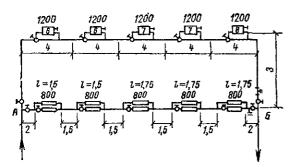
28 Горизонтальные однотрубные ветви двух верхних этажей системы водяного отопления многоэтажного здания с нижней разводкой магистралей
